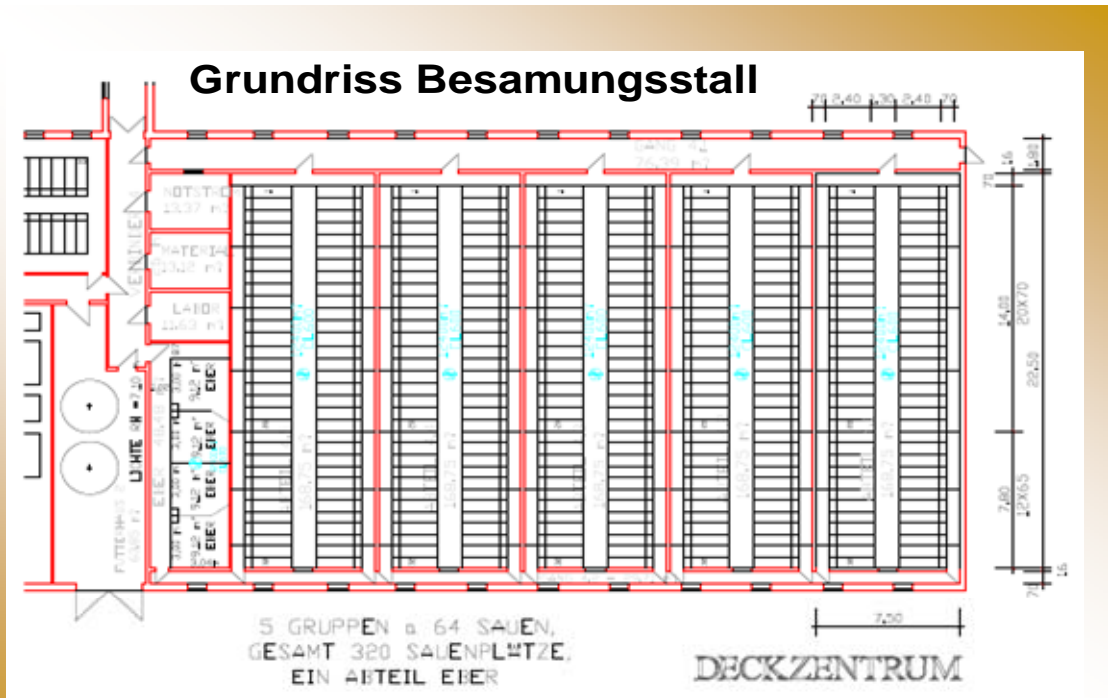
Grundriss eines kombinierten Besamungs- und Wartestalles nach dem Kammstallprinzip
